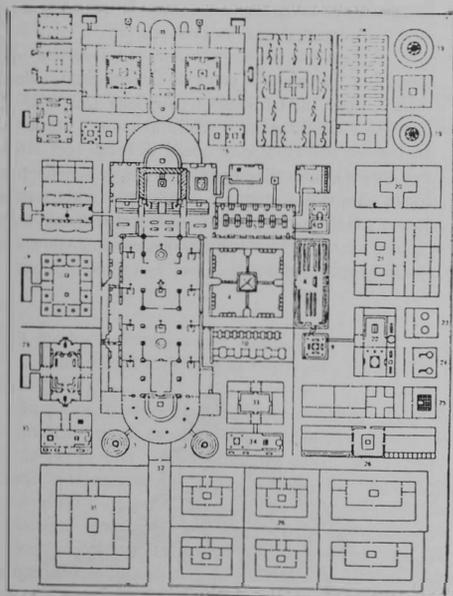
Pianta dell'abbazia benedettina ottocentesca di San Gallo (da Fondazione Della Rocca).
